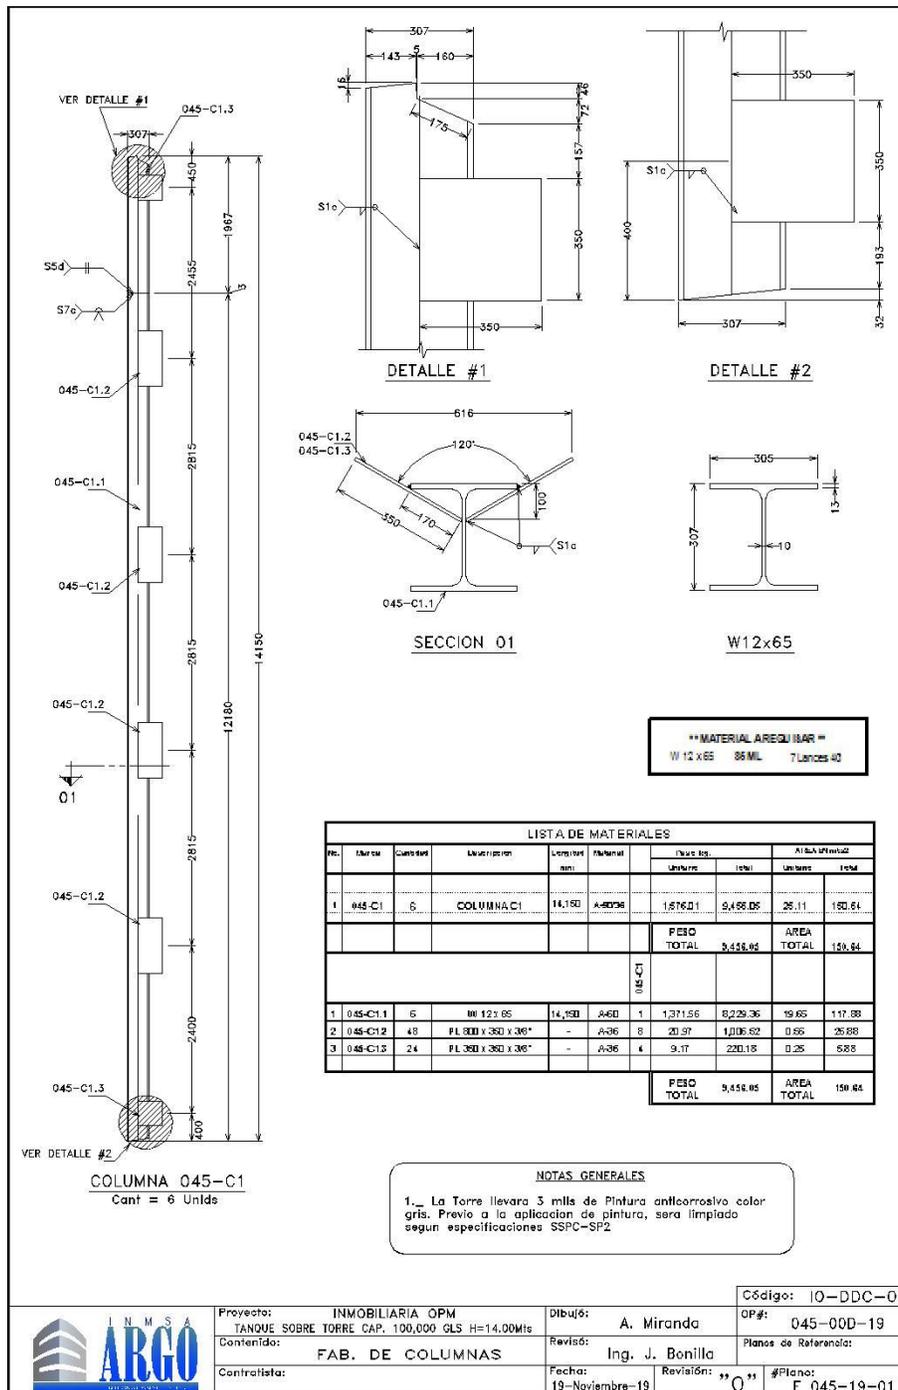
Plano de fabricación de columnas para torre de tanque elevado, Inmobiliaria OPM
